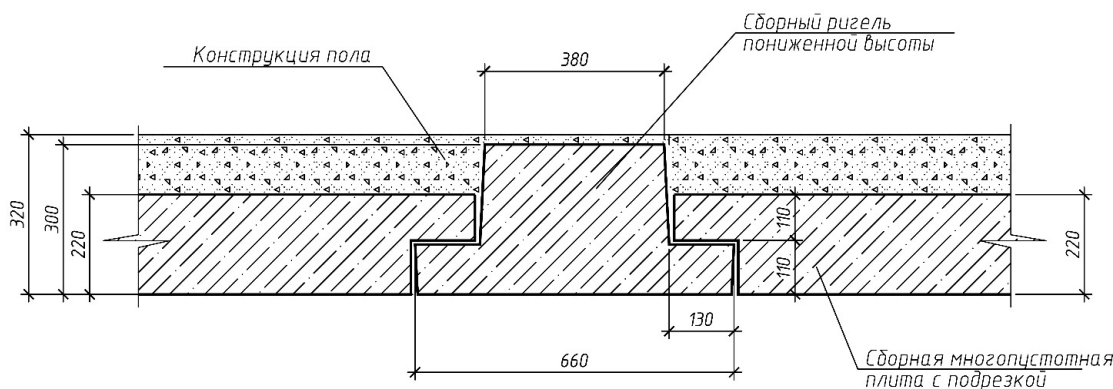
Узел сопряжения плит перекрытия с ригелем
